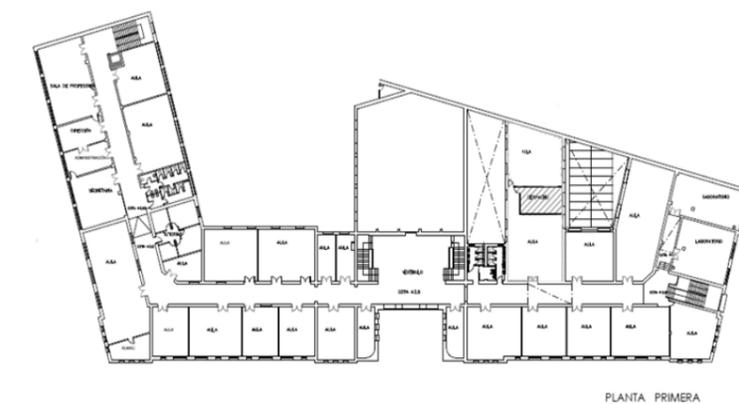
Planimetría del proyecto simplificado de obras de reformas interiores, Área Técnica de Construcciones y Equipamientos de la Dirección Provincial de Valladolid.
